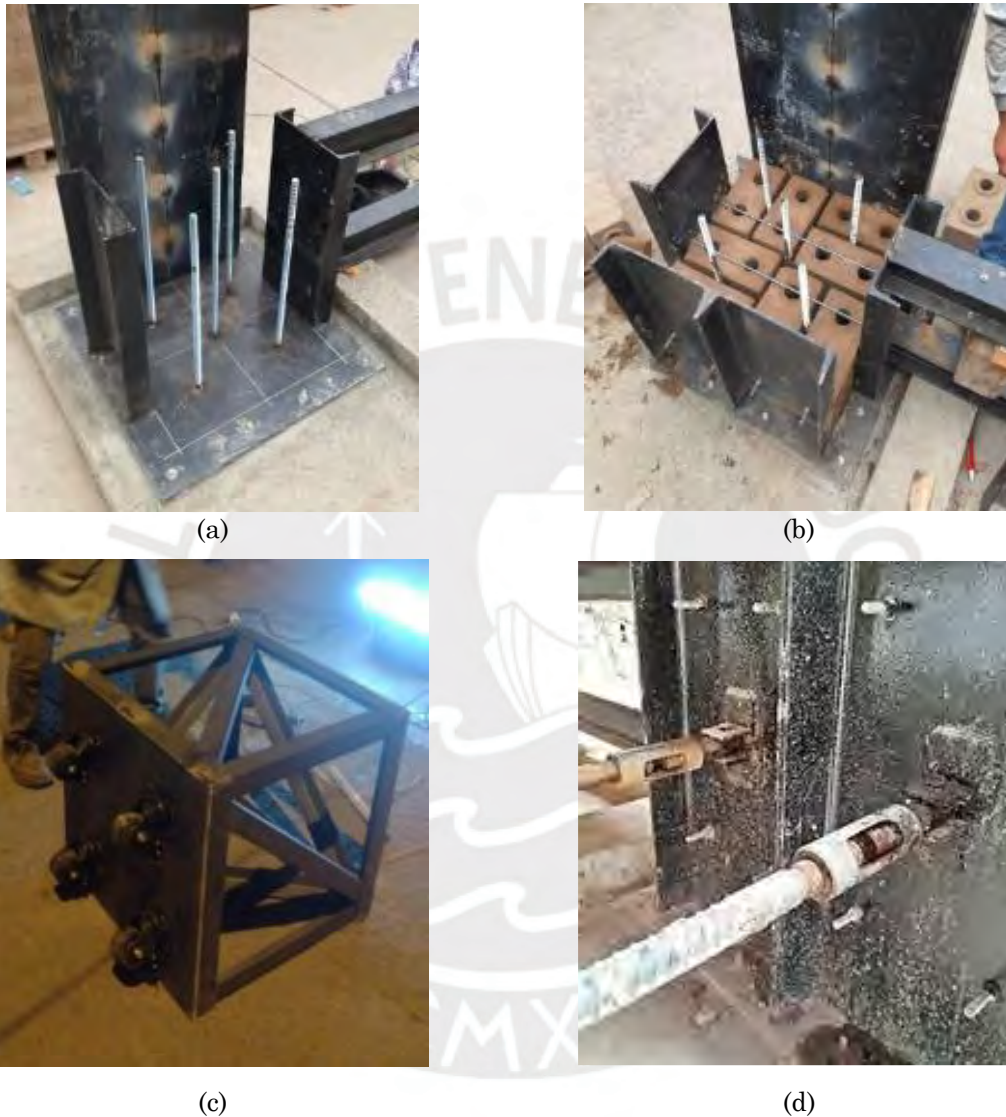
Construcción del sistema de apoyos: (a) perfiles y espárragos verticales soldados a la base, (b) espárragos horizontales y verticales embebidos en la mampostería, (c) refuerzo interno de las cajas metálicas, y (d) mecanismos de pretensado de las barras biarticuladas.
